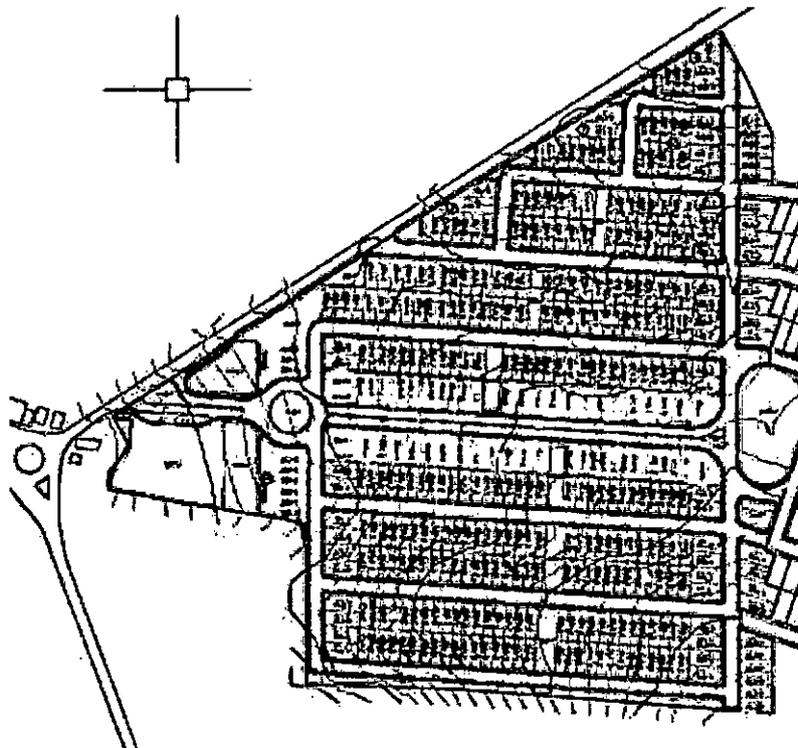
Loteamento Top Park - Novo Horizonte, planta urbanística.
